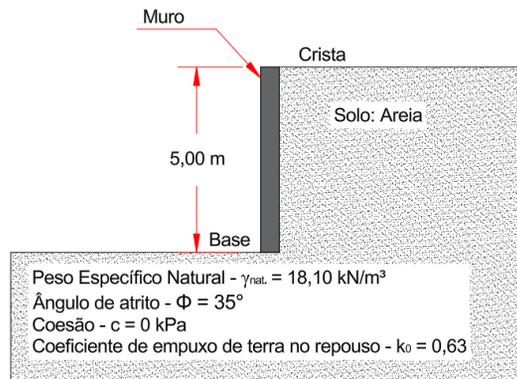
Muro de arrimo (adaptado de Das e Sobhan, 2019).
